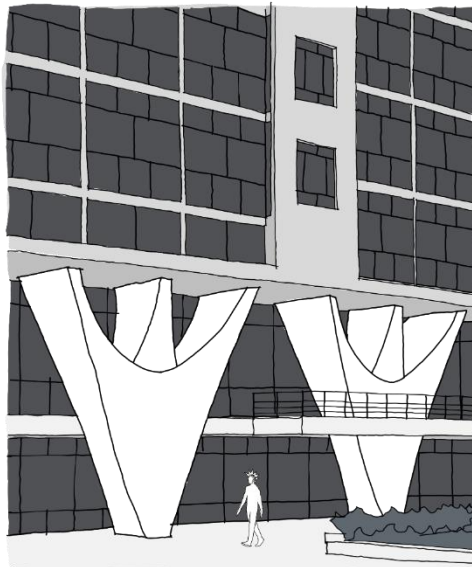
Pilares do Conjunto JK – desenho nosso.
